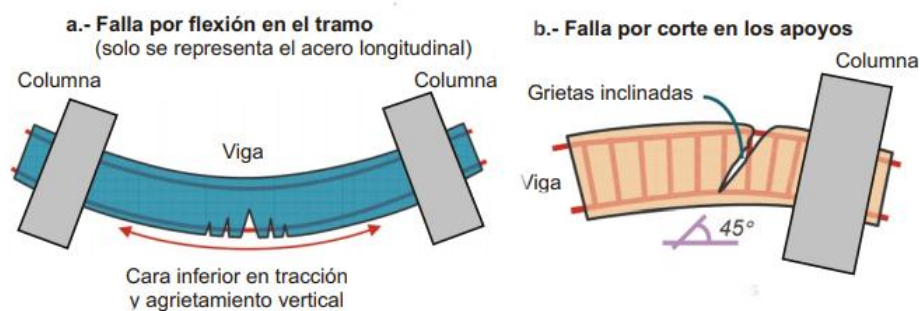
Fallas por grietas en vigas. Fuente: CIVILGEEKS
